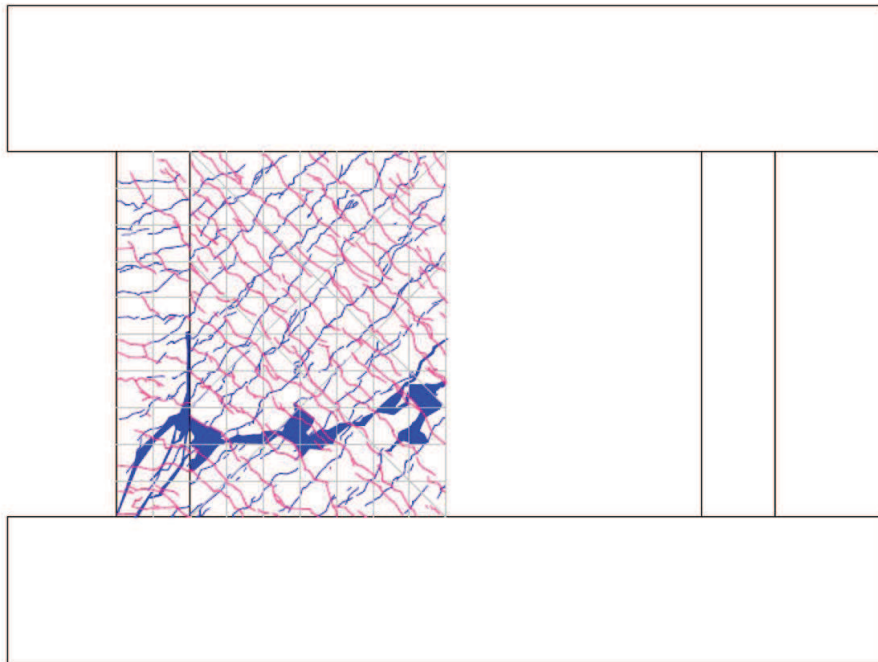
試験体 S-13-DIII 最終破壊時ひび割れ図
